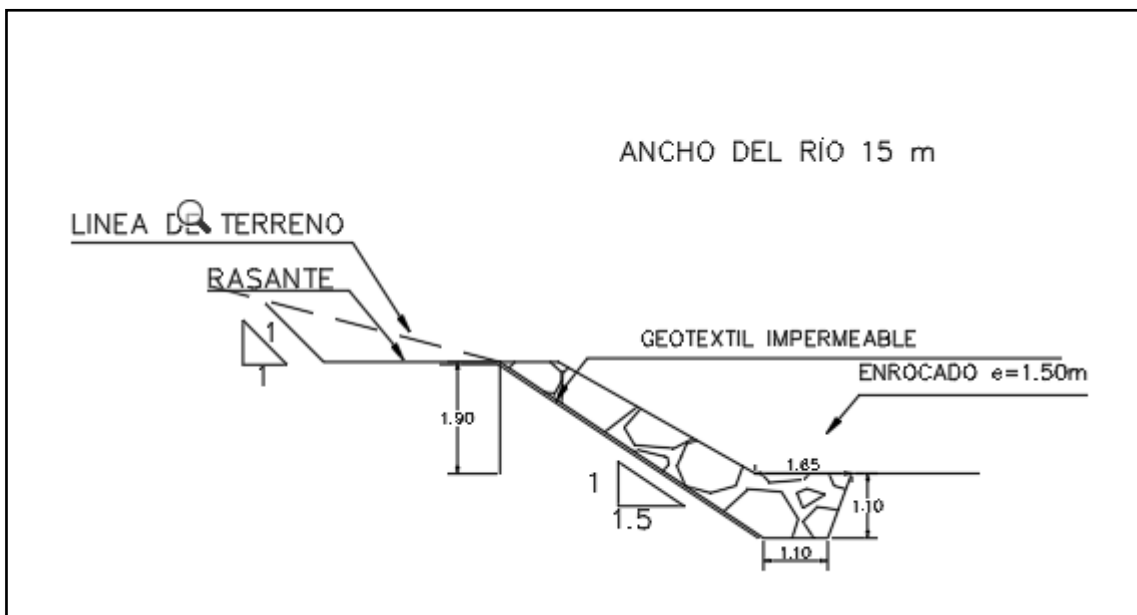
Detalle de espesor de la roca 1.5 m - Revisar planos en anexos.
